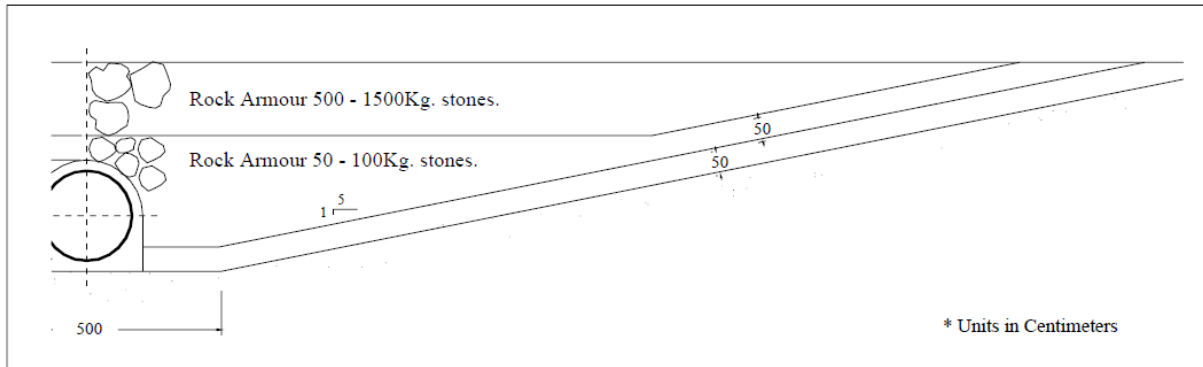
Perfil transversal de uma solução de proteção estrutural. Trincheira escavada sobre fundo arenoso com enchimento de enrocamento. *Alvarez et al., 2002
